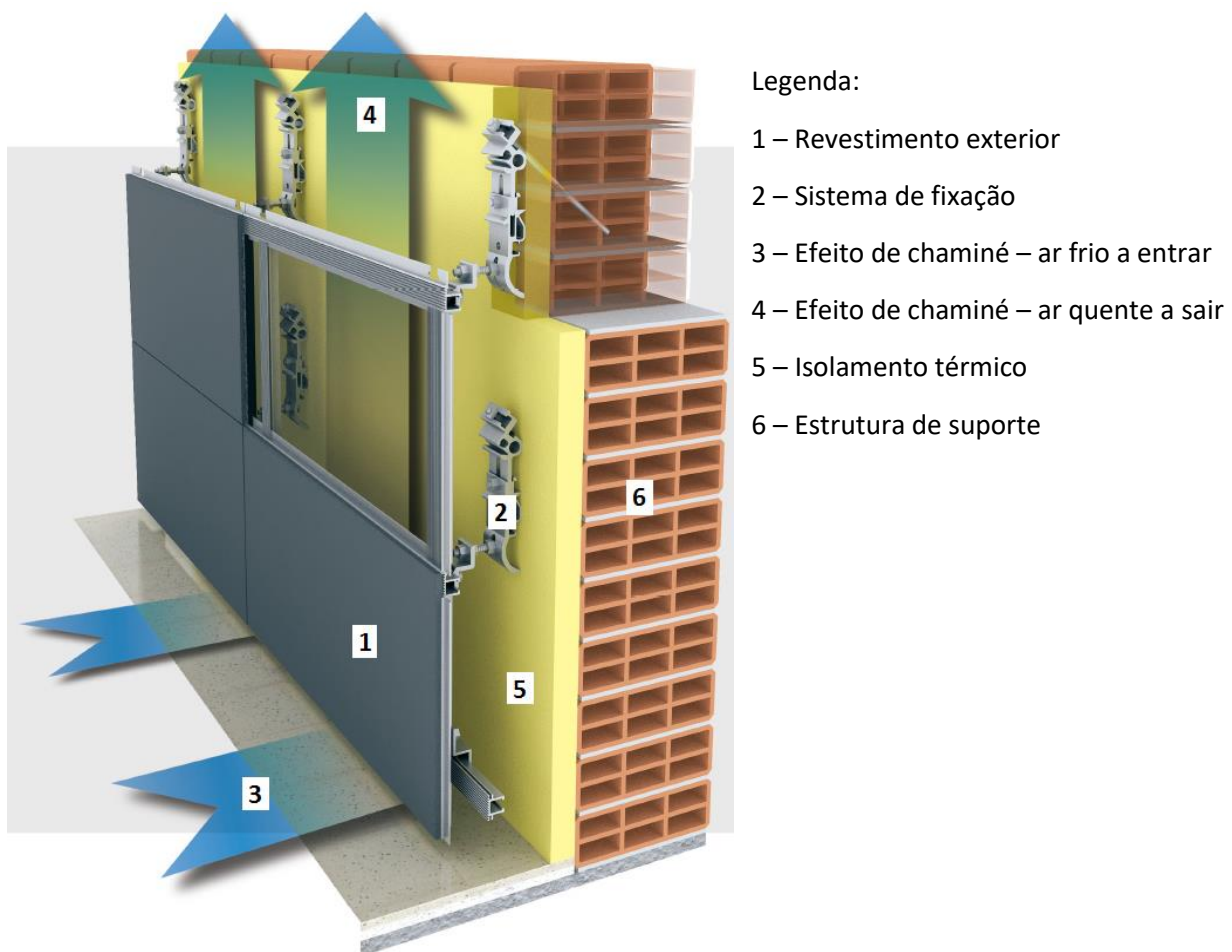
Composição de um sistema de fachada ventilada. [69]
